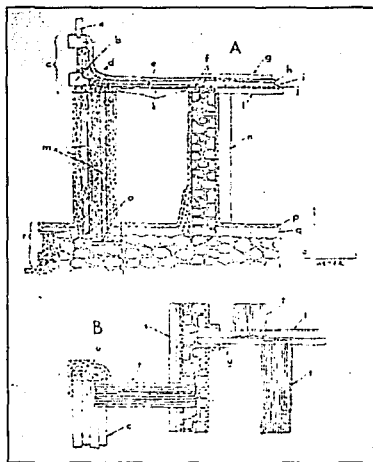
Corte estructural de una sección de Atetelco y planta de colocación del maderamen en los techos. Tomado de Amador Sellerier. *Diseño y trazo urbano en Teotihuacan*, p. 273
